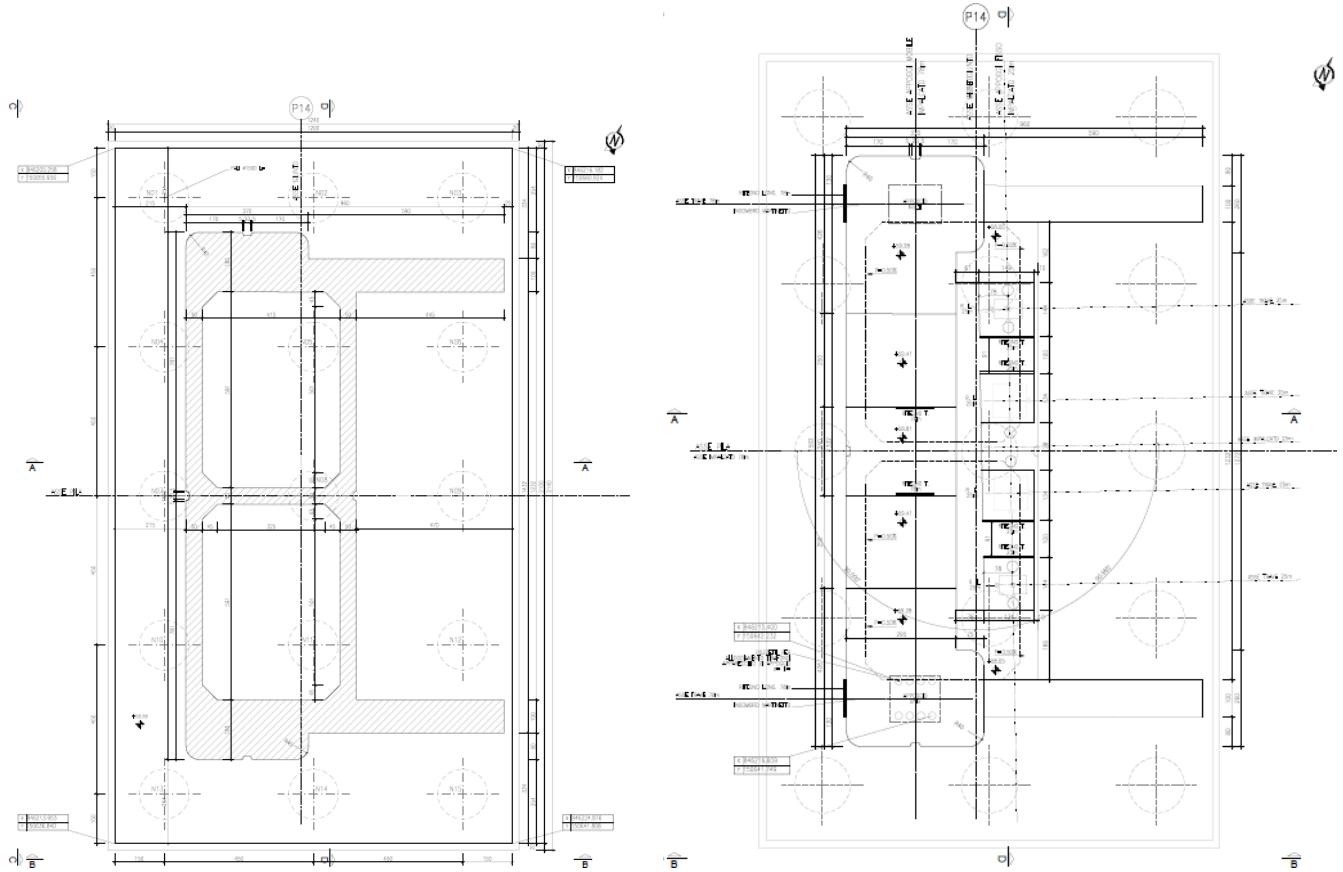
Pianta fondazioni (a sinistra) e pianta pulvino (a destra)
